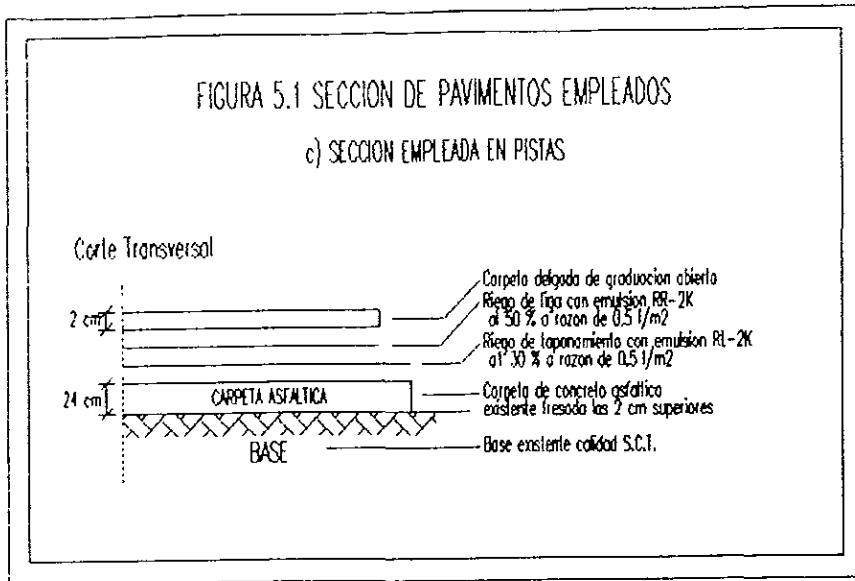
SECCION DE PAVIMENTOS EMPLEADOS
